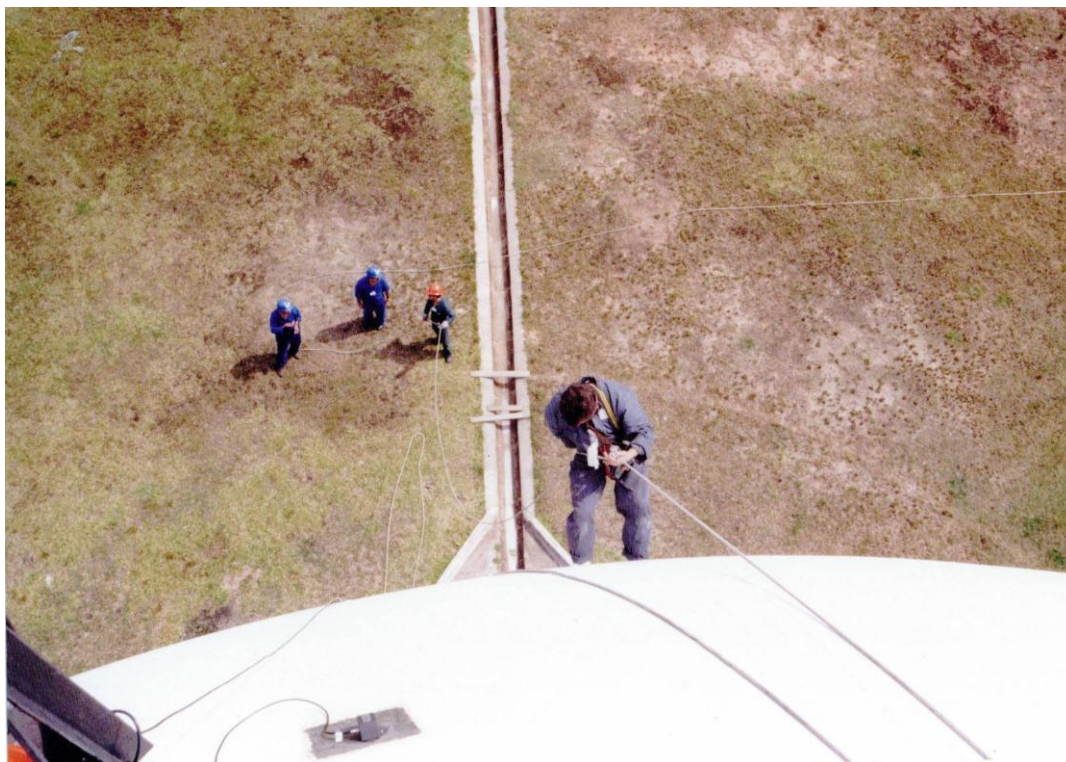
Alpinista se deslocando para colocação em outro ponto
